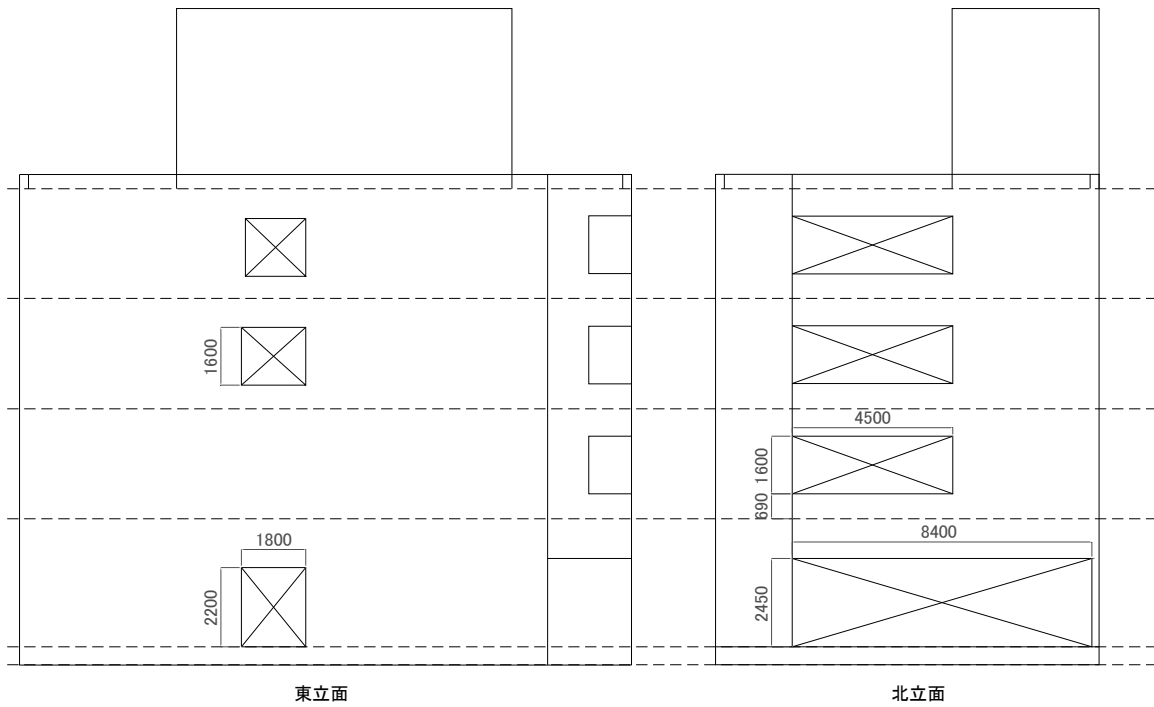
調査対象建物 立面図 (単位: mm)
